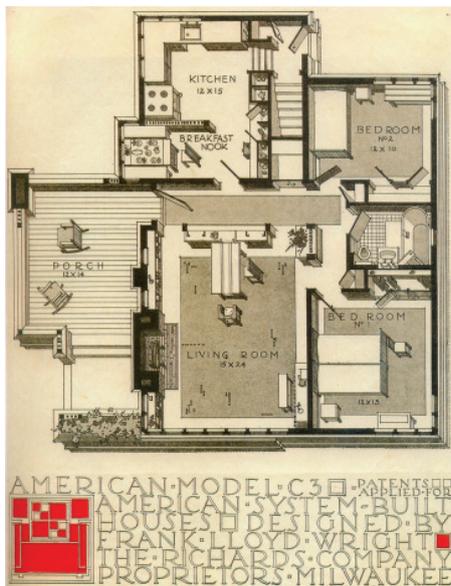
Planta do Modelo C-3, 1915-17, American System-Built Homes
